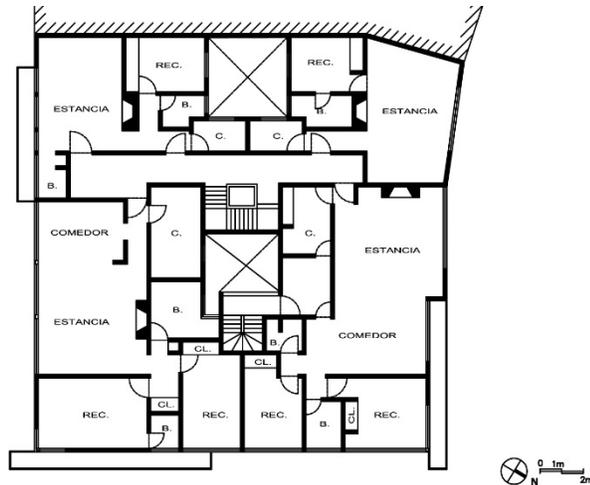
Planta tipo del edificio de apartamentos Garza del arquitecto Luis Barragán en colaboración con José Creixell, ubicado en la plaza de Melchor Ocampo núm. 40, ca.1940
